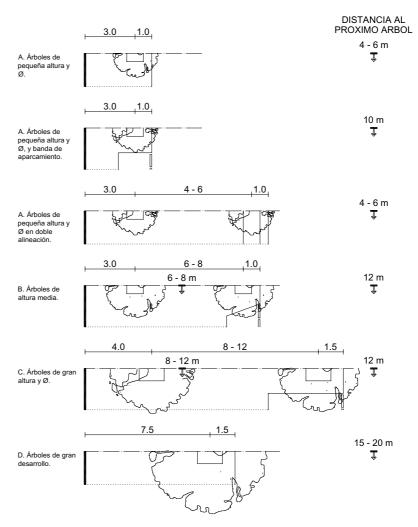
DISTANCIAS ENTRE EDIFICACIÓN, ARBOLADO, Y CALZADA
